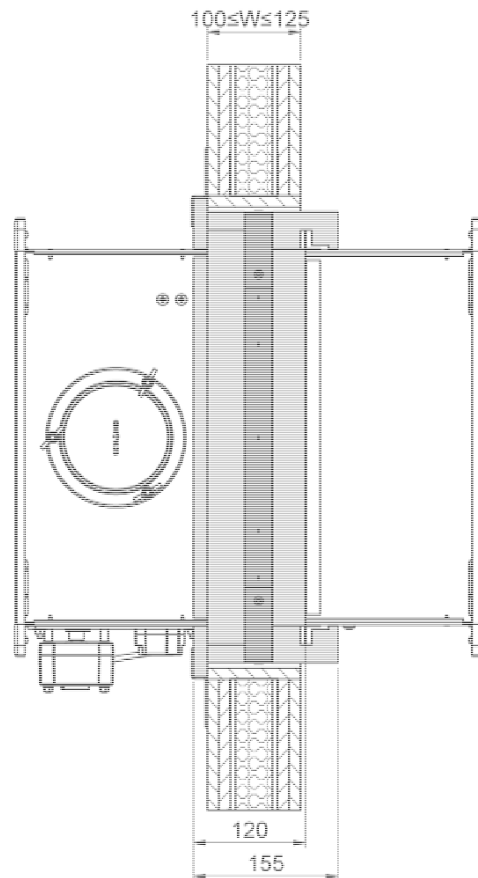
voorbeelden voor aantal en positionering van de bevestigingslippen bij inbouwframe type ER-A1
